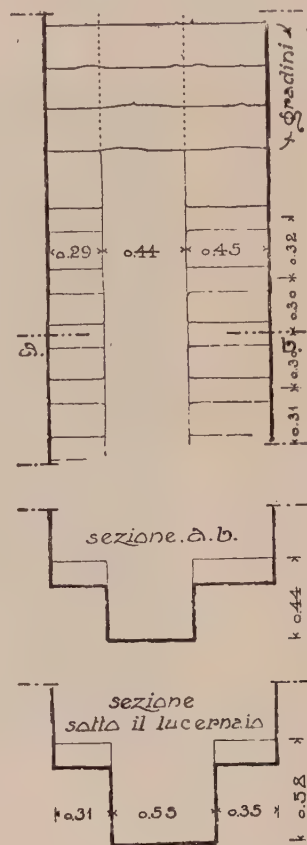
Pianta e sezione del cunicolo sotto l'arena.
